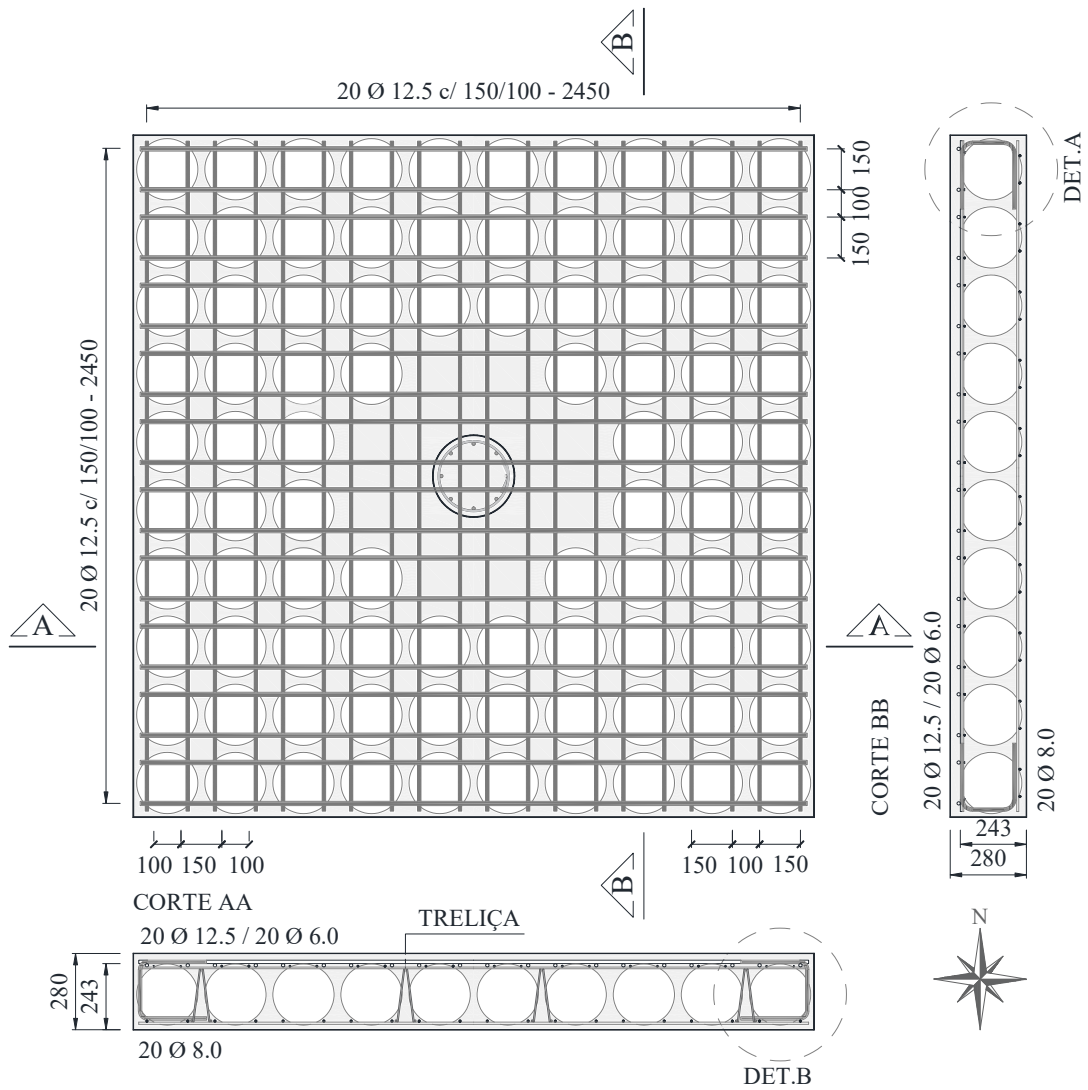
Armaduras de flexão das lajes sem pré-laje
